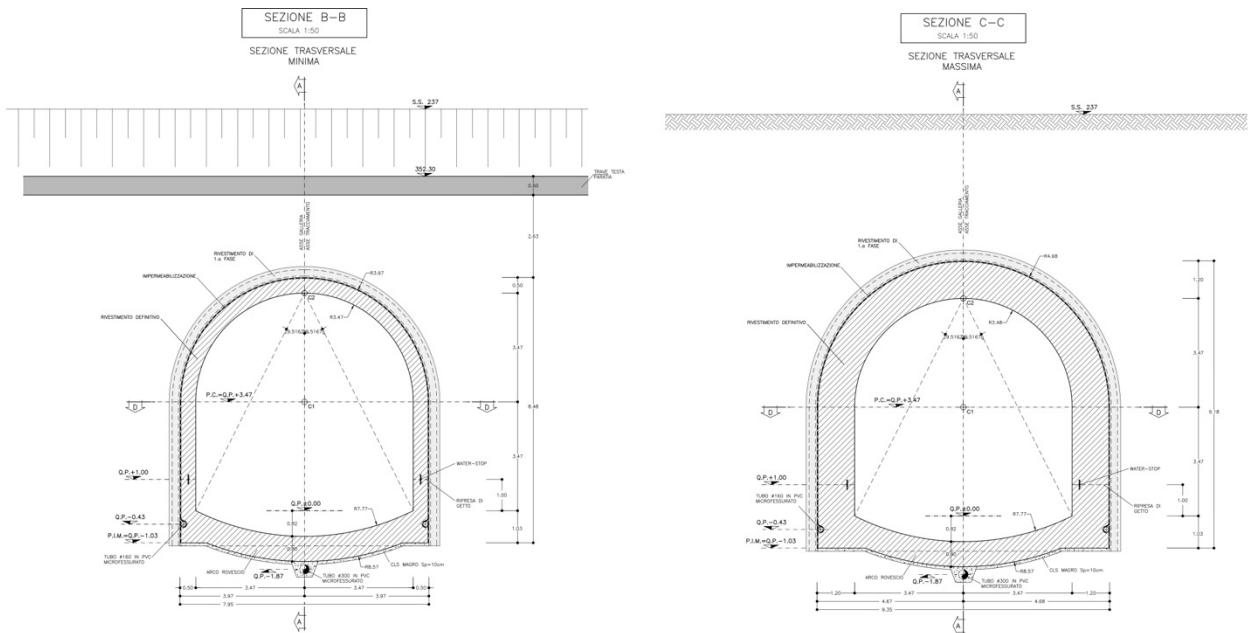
Sezione di Attacco – Carpenteria – Sezioni
